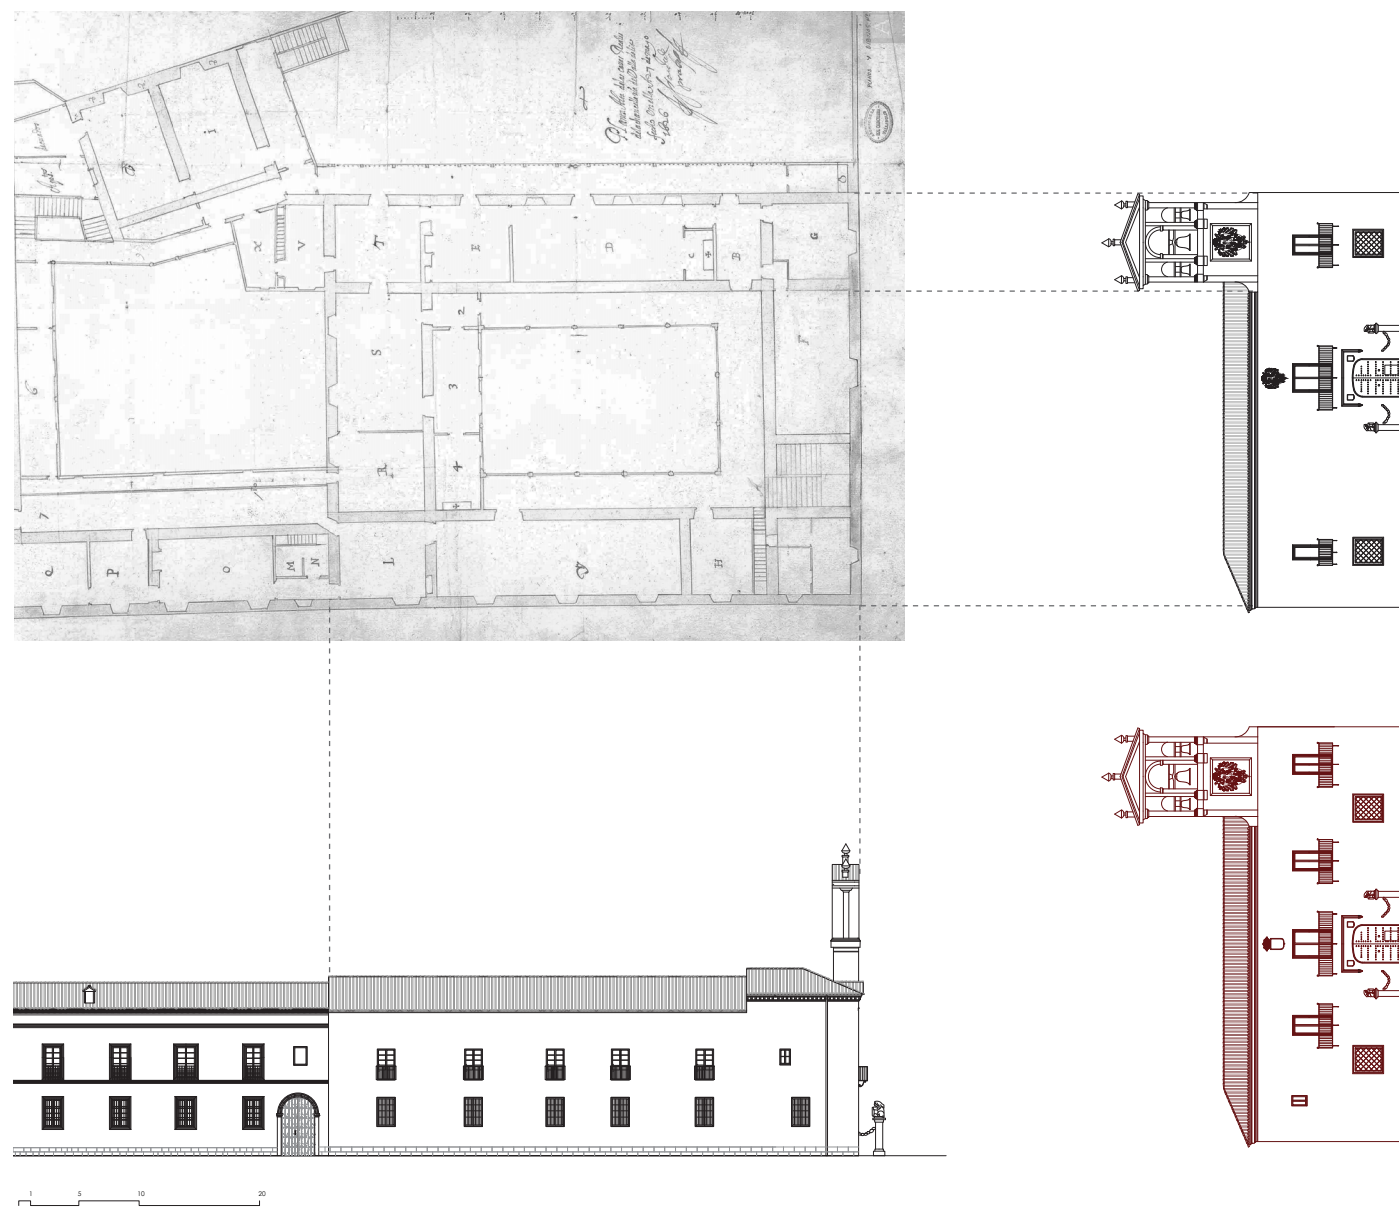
Plano de planta primera de la Chancillería de Valladolid y parte del nuevo Archivo de Chancillería, 29 de mayo de 1626. Obtenido de <https://pares.cultura.gob.es>
